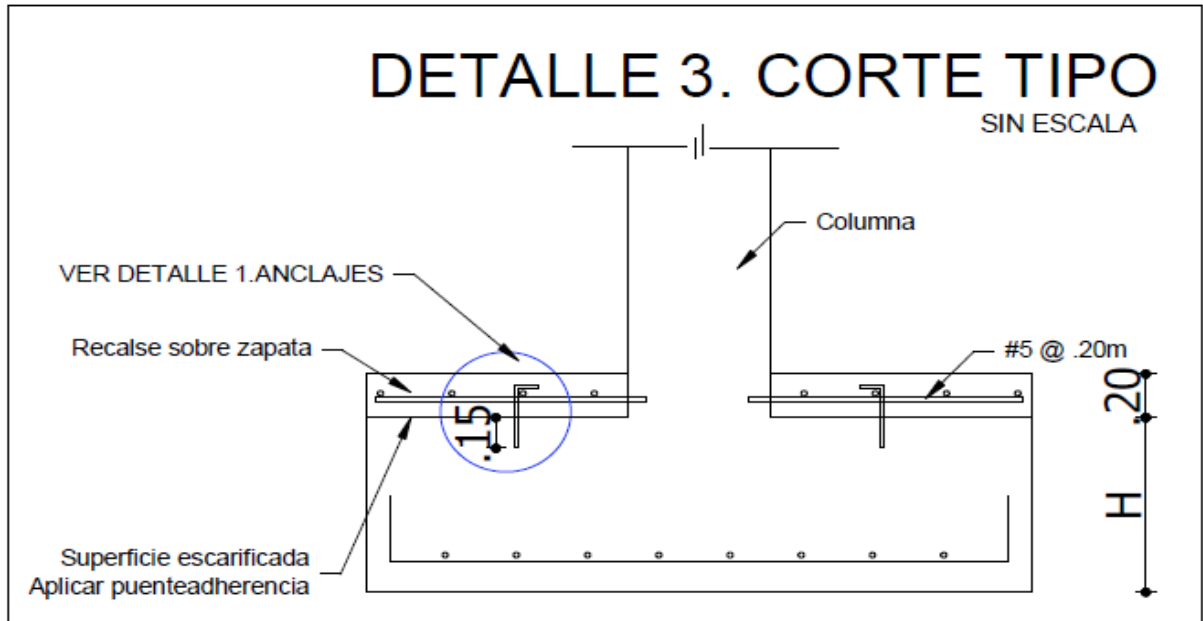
Anclajes con varillas de 1/2" en los dados de concreto.
